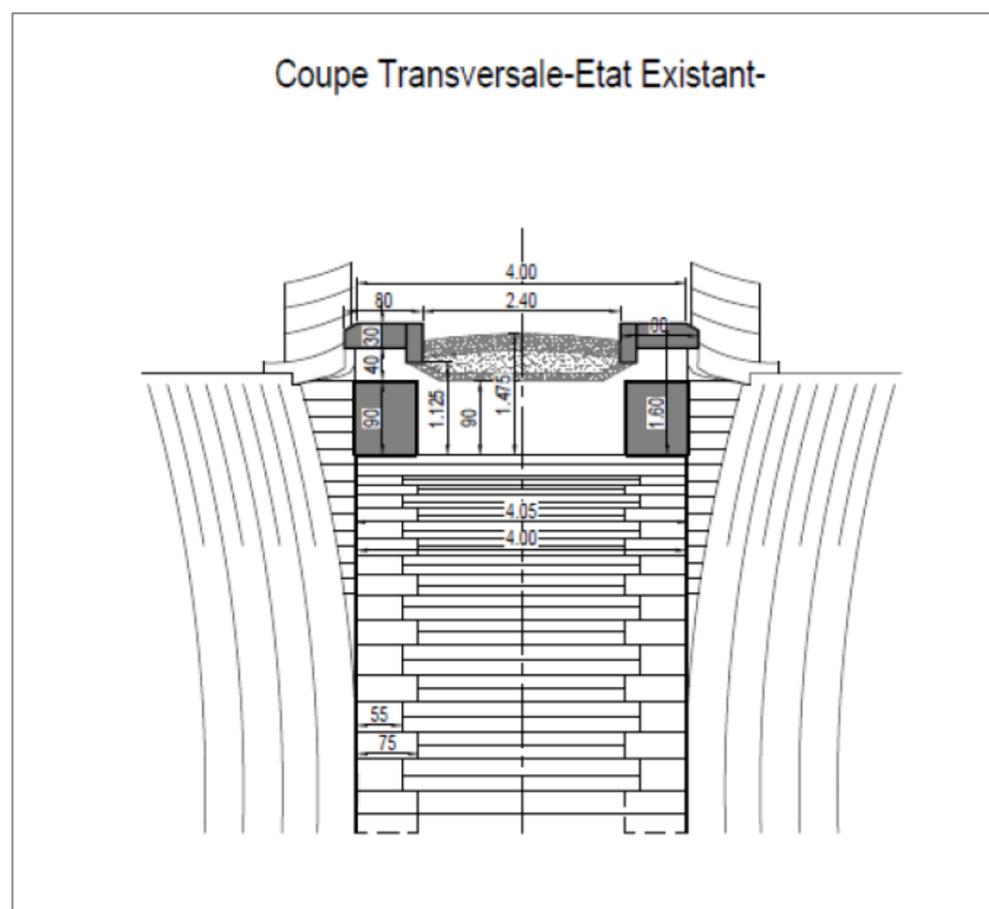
Coupe transversale type du pont existant « route des Volières »
